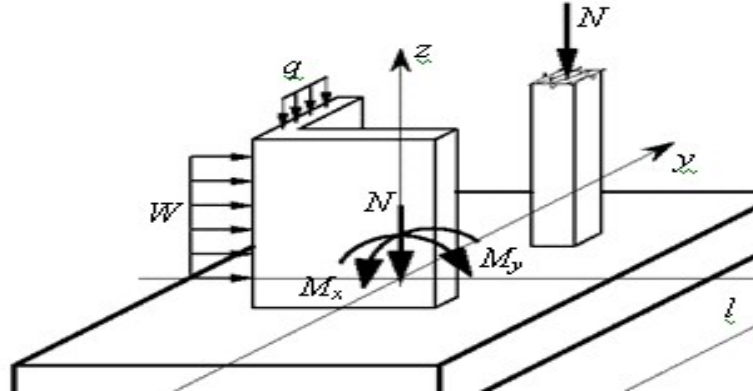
Схема для розрахунку плити при абсолютно жорсткому фундаменті (розрахунок за першою схемою).
